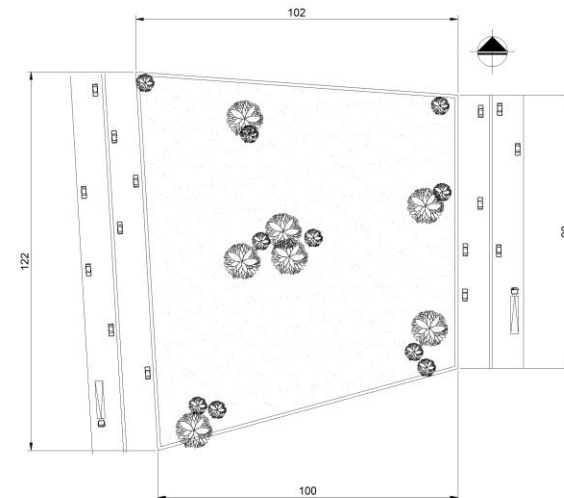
Planta del polígono propuesto para el diseño del nuevo INSIVUMEH.
